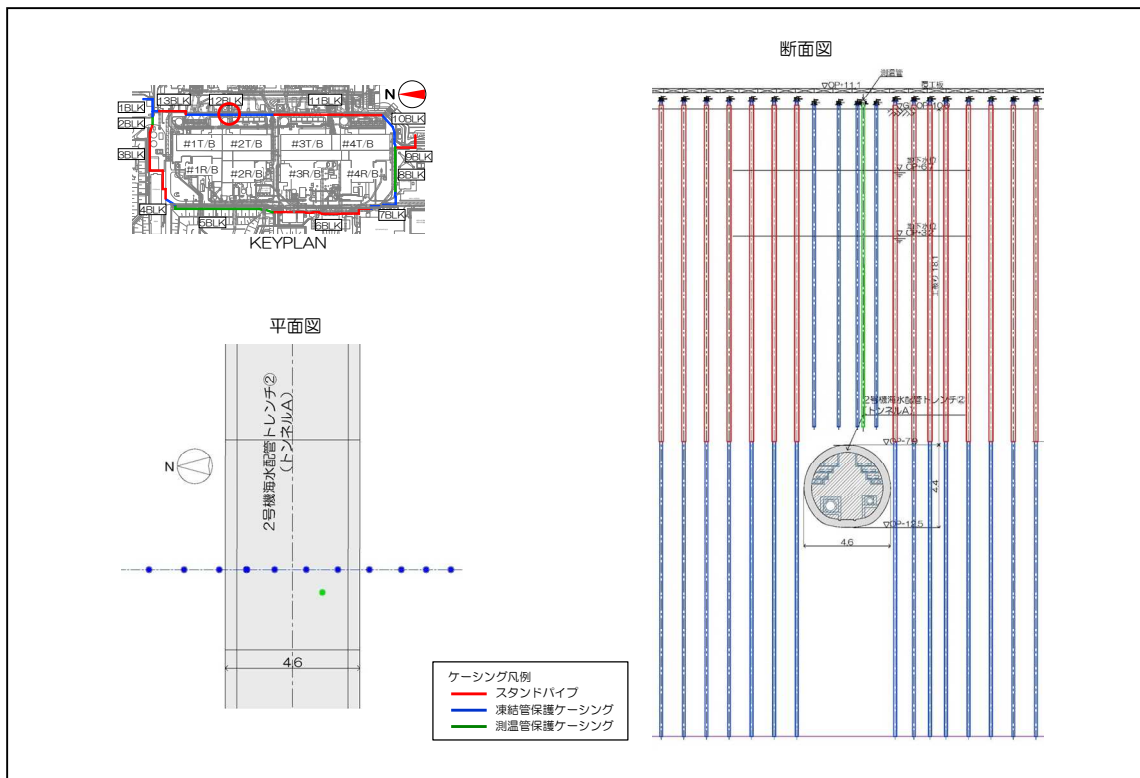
2号機海水配管トレンチトンネルA部 施工平面図・断面図
